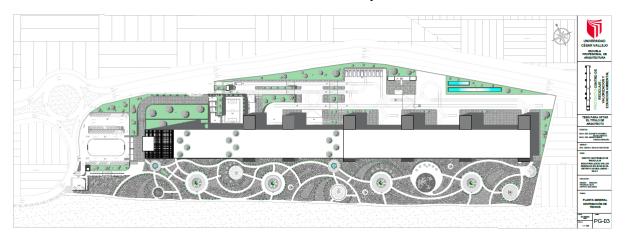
Plano General – Plano de Techos FUENTE: Elaboración Propia
